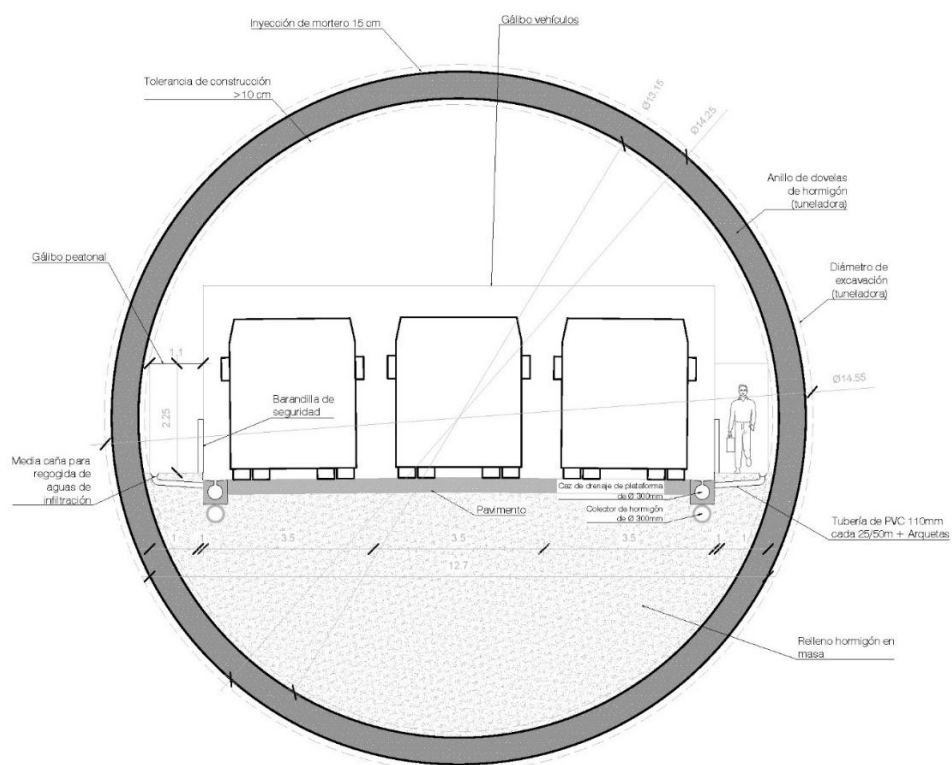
Sección tipo 3 carriles. Tuneladora. Diámetro de excavación  $\varnothing=14,55$  m
